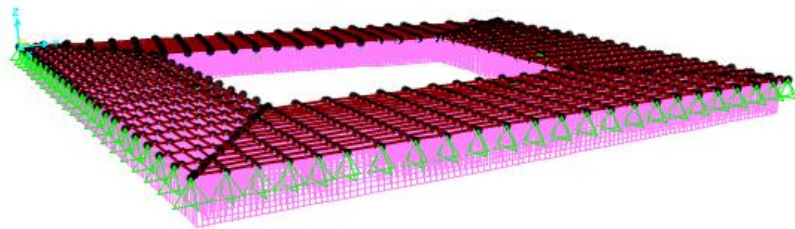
Cargas por viento cubierta Plana en Terraza - SAP2000. Fuente: Autores
